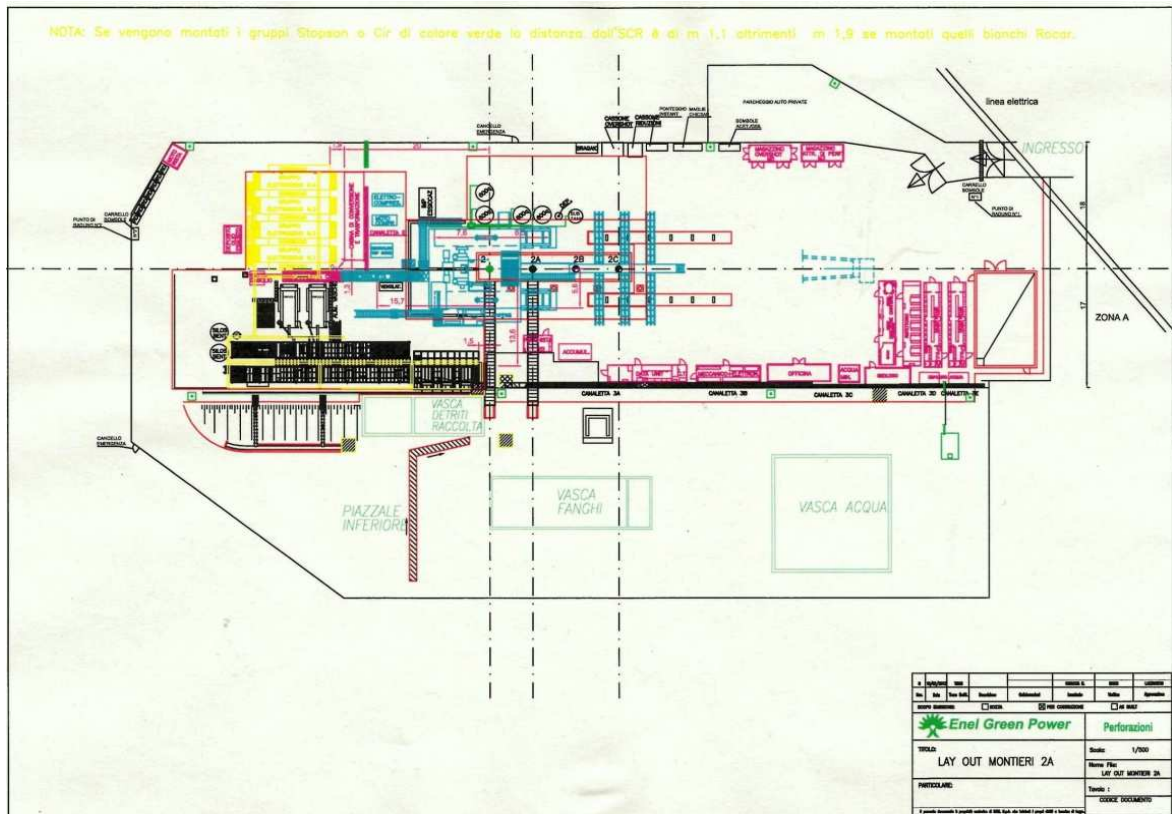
Layout generale impianto di perforazione MAS 6000 E
